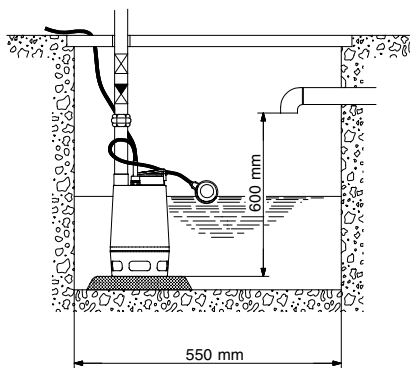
Dimensões mínimas do poço quando o boiador está configurado para o comprimento mínimo de cabo livre
